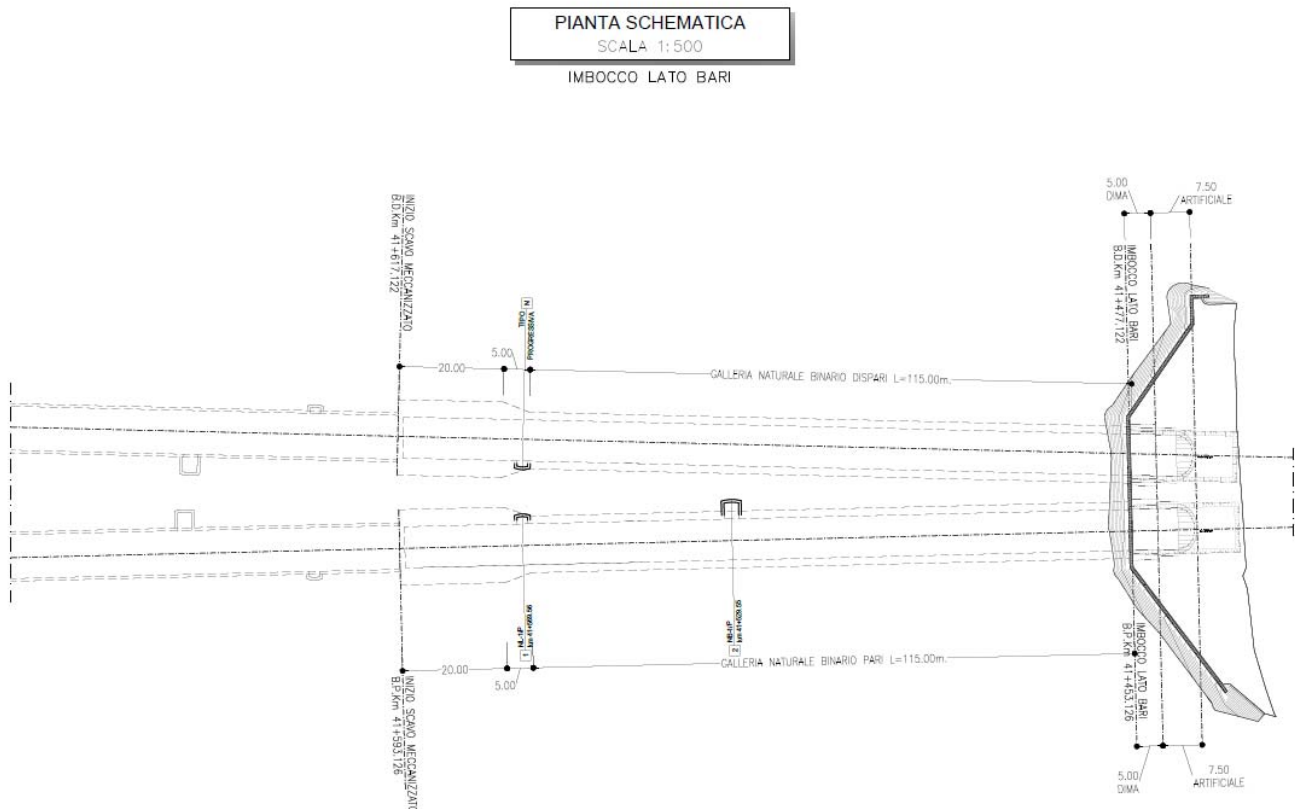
planimetria generale tratta in tradizionale lato Bari
